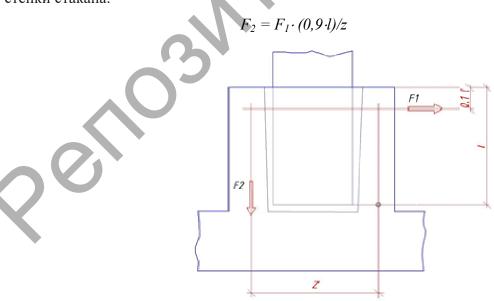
Расчетная схема для определения вертикальной арматуры стакана
